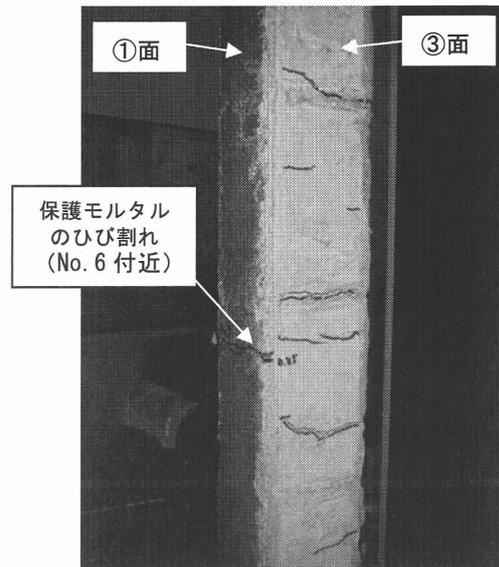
保護モルタルひび割れ発生直後の状況 (A体最大ひび割れ幅0.25mm時)
